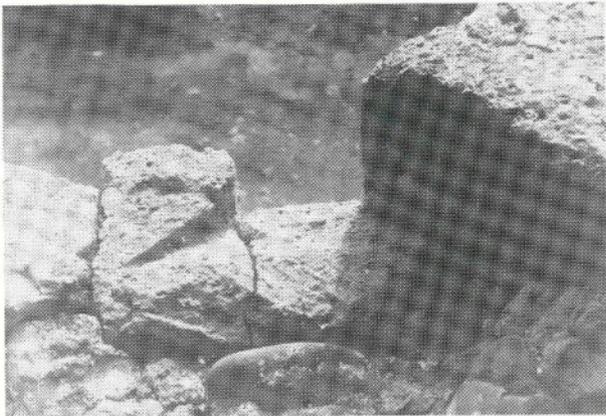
Primo piano: particolare del concio con intaglio a sguincio in corrispondenza della finestra sul prospetto S.
